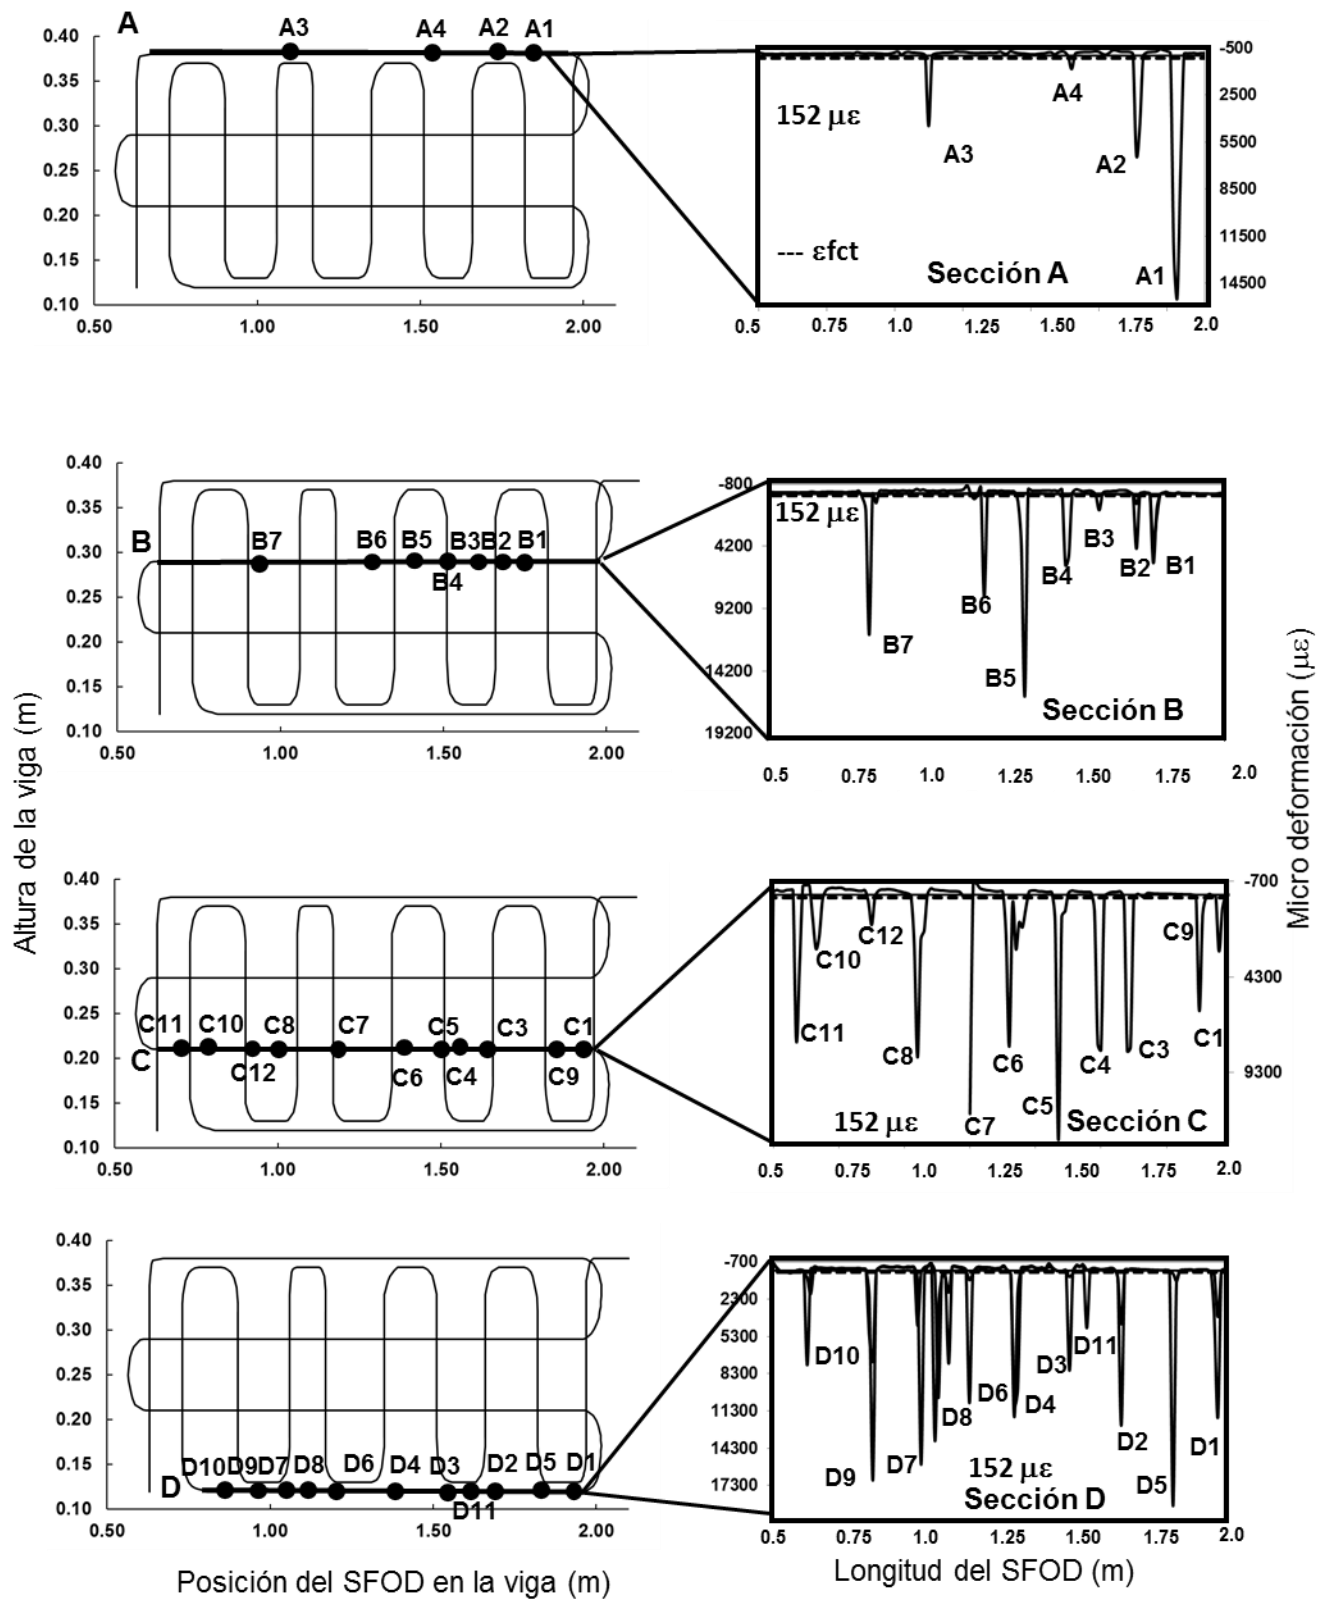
Deformaciones en las secciones A, B, C y D del SFOD1 en la viga I-2(224 kN).
